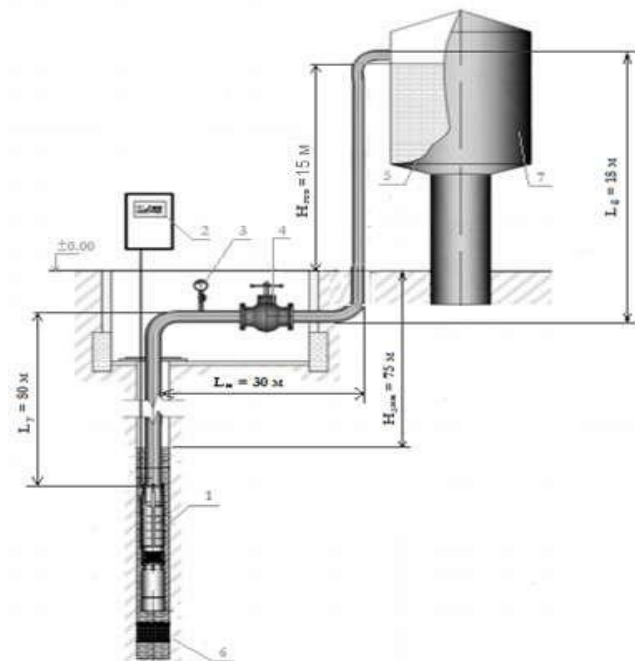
Схема скважины с трубопроводом и водоприемной башней:
